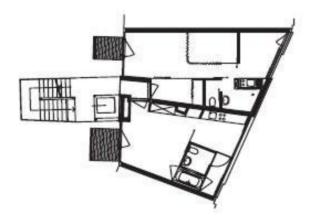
Planta Arquitectónica del tercer nivel con uso habitacional.
